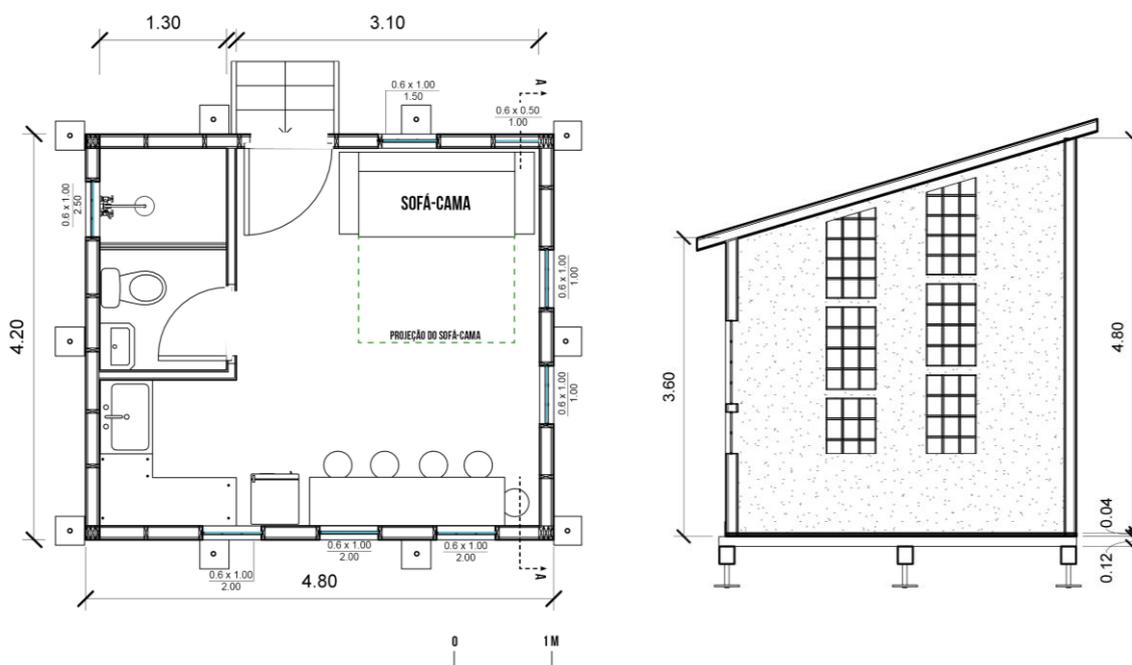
Planta e corte do embrião habitacional – Fonte: elaborado pelos autores (2018)
